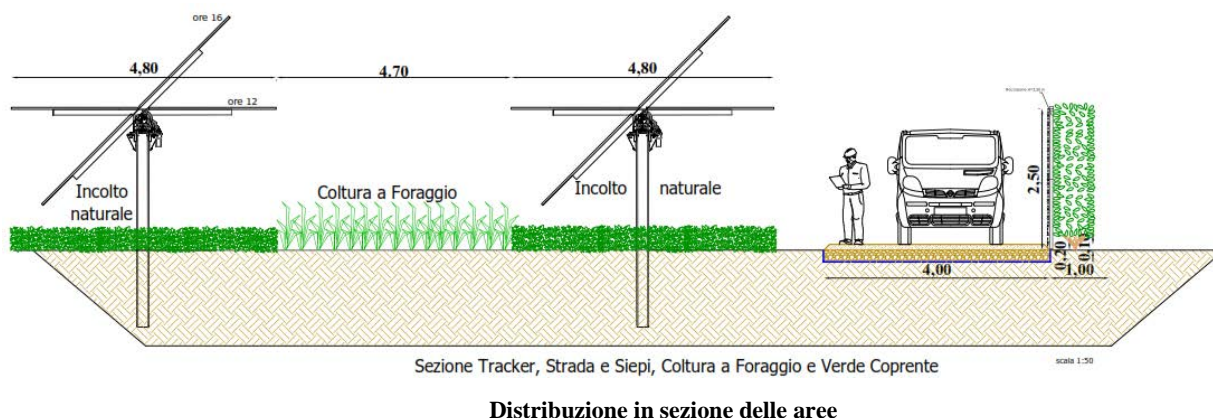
Schema (pianta e sezione) dell'impianto agrovoltaico
